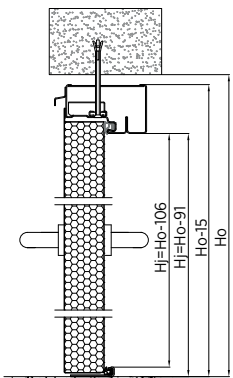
Pose au mur – bloc-porte à deux vantaux – bâti intérieur à rupture de pont thermique – coupe verticale
